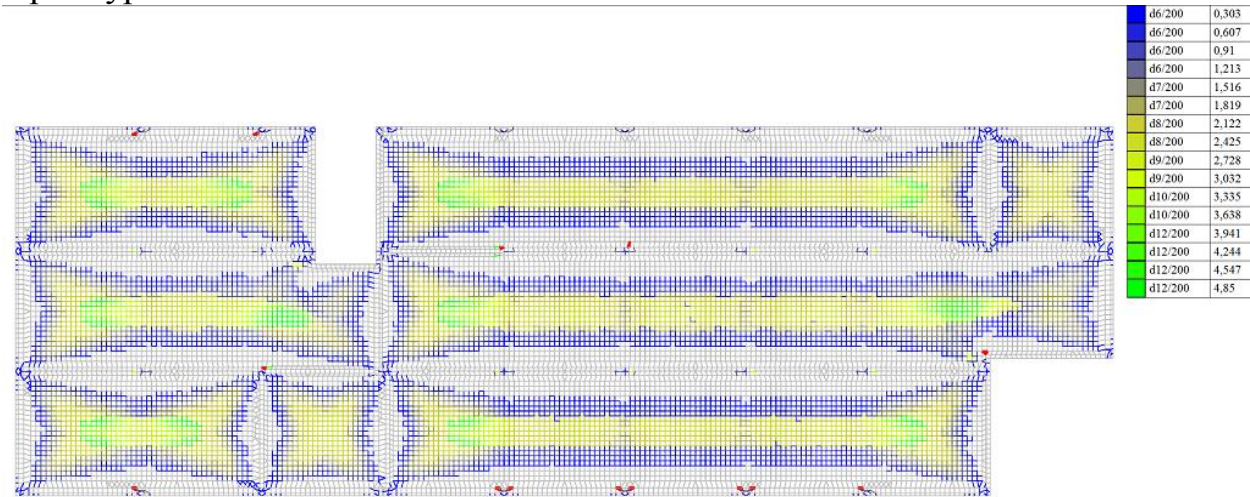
Схема нижнего армирования плиты по оси x.
